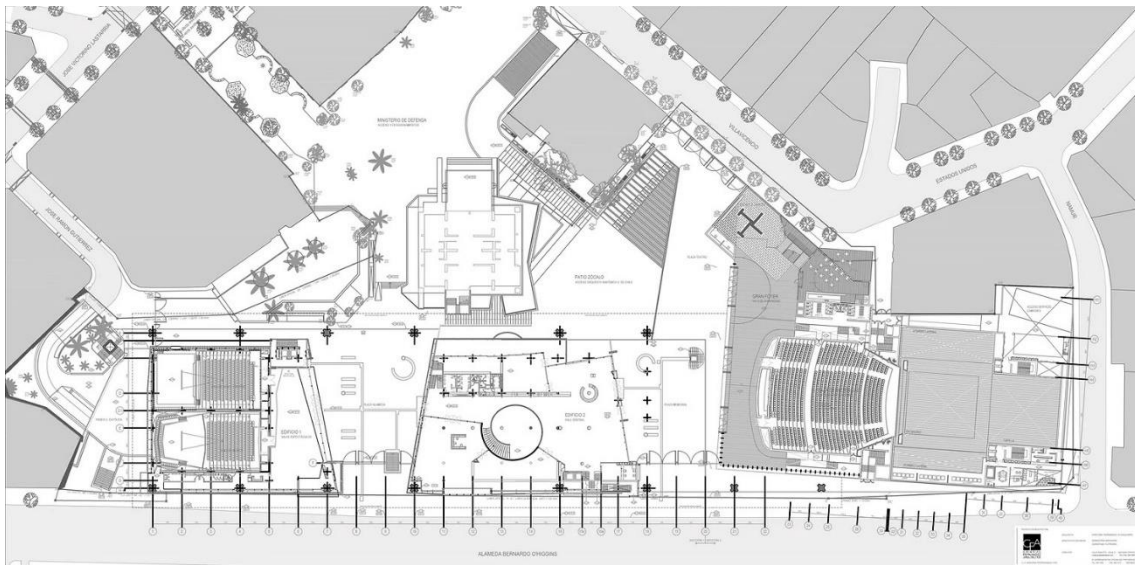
Planta arquitectónica del primer nivel, etapa 1.
